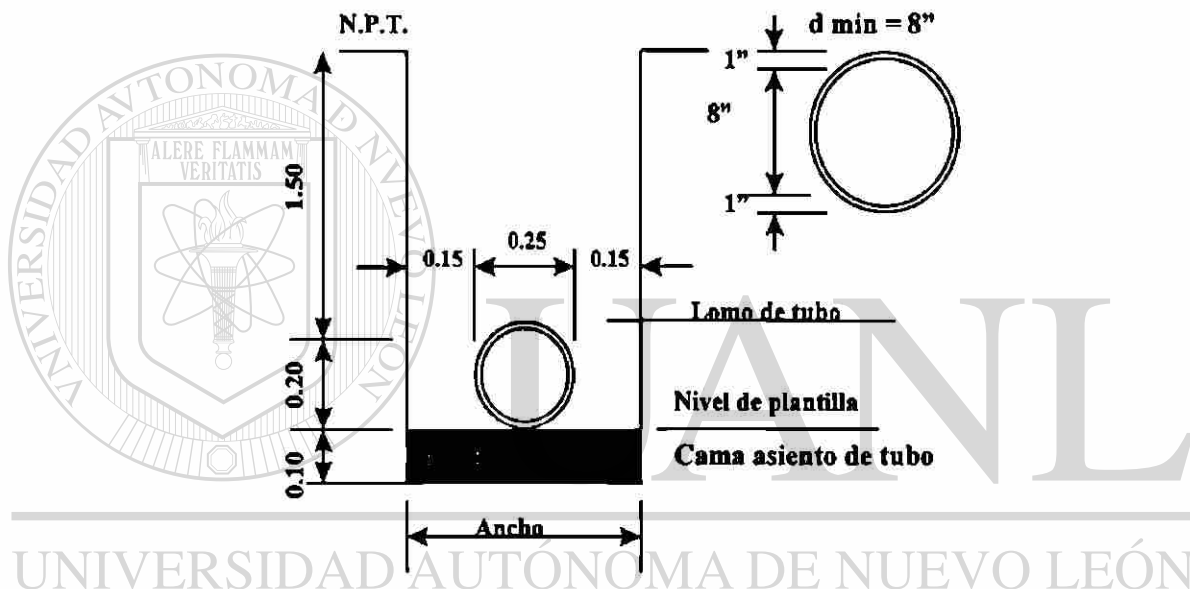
Detalle de una zanja para tubería de red de alcantarillado ®
